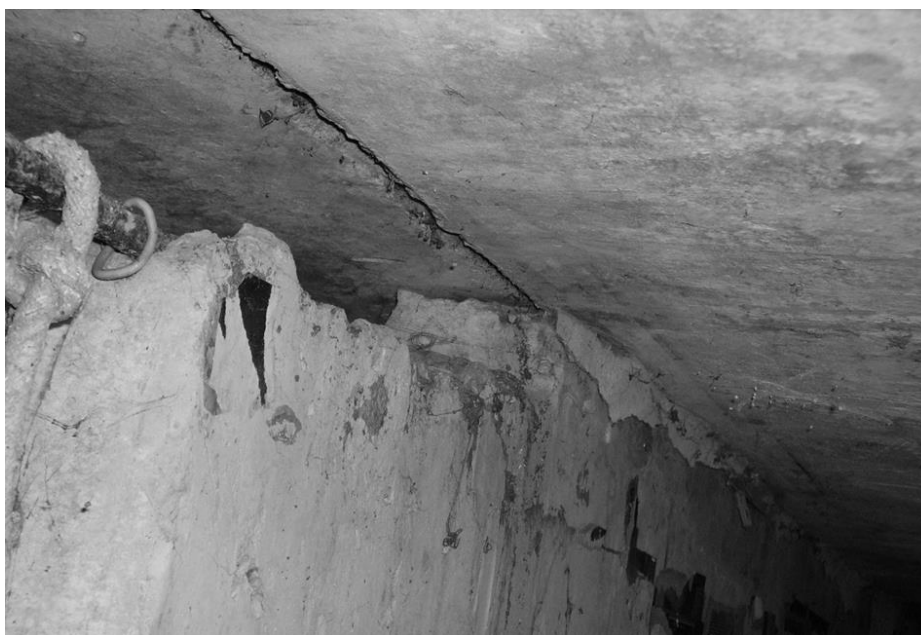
Отсутствие опирания панели перекрытия над подвалом с несущей стеной
